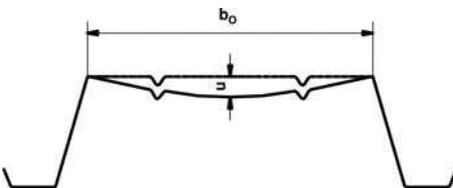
Obergurtverformung für Warmdachausführungen: Beschränkung der Obergurtdurchsenkung nach DIN 18 807-3 bei Dachaufbau mit geklebtem Schichtenpaket
